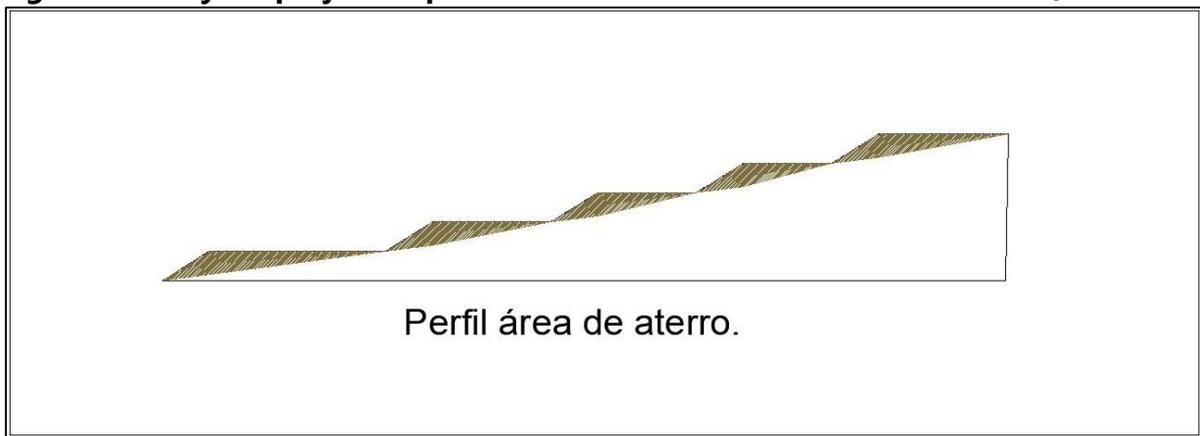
Layout projetado para extensão do aterro Fase 1. Perfil de Área.
